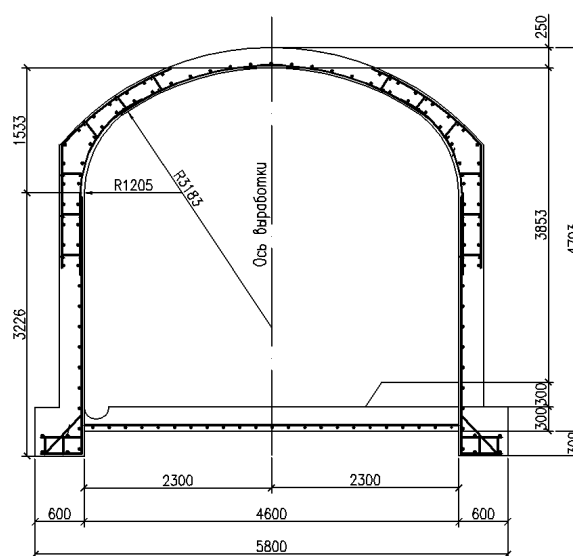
Поперечное сечение конструкции протяженной железобетонной устьевой части ствола №5-Г, на руднике Гужумсай
